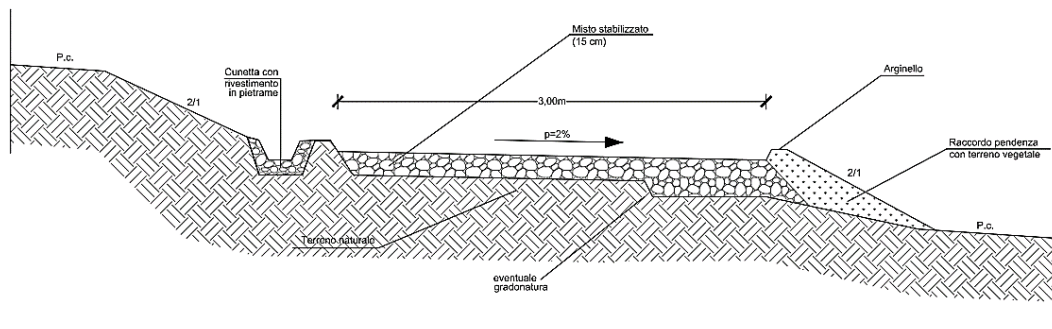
Sezione tipo strade interne al sito, tipologia a mezza costa (Fonte: ns elaborazione)
